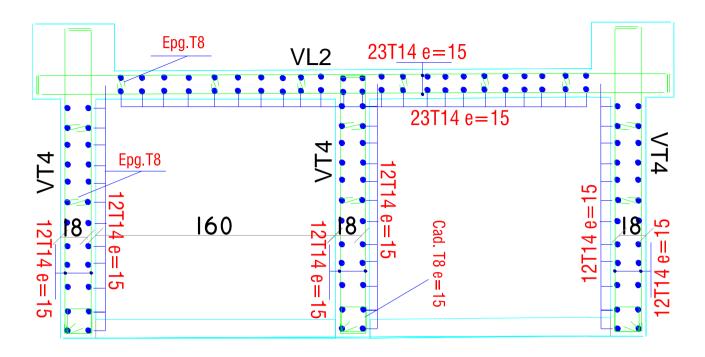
Coupe horizontale de Ferraillage des voiles de l'ascenseur au niveau de RDC.
